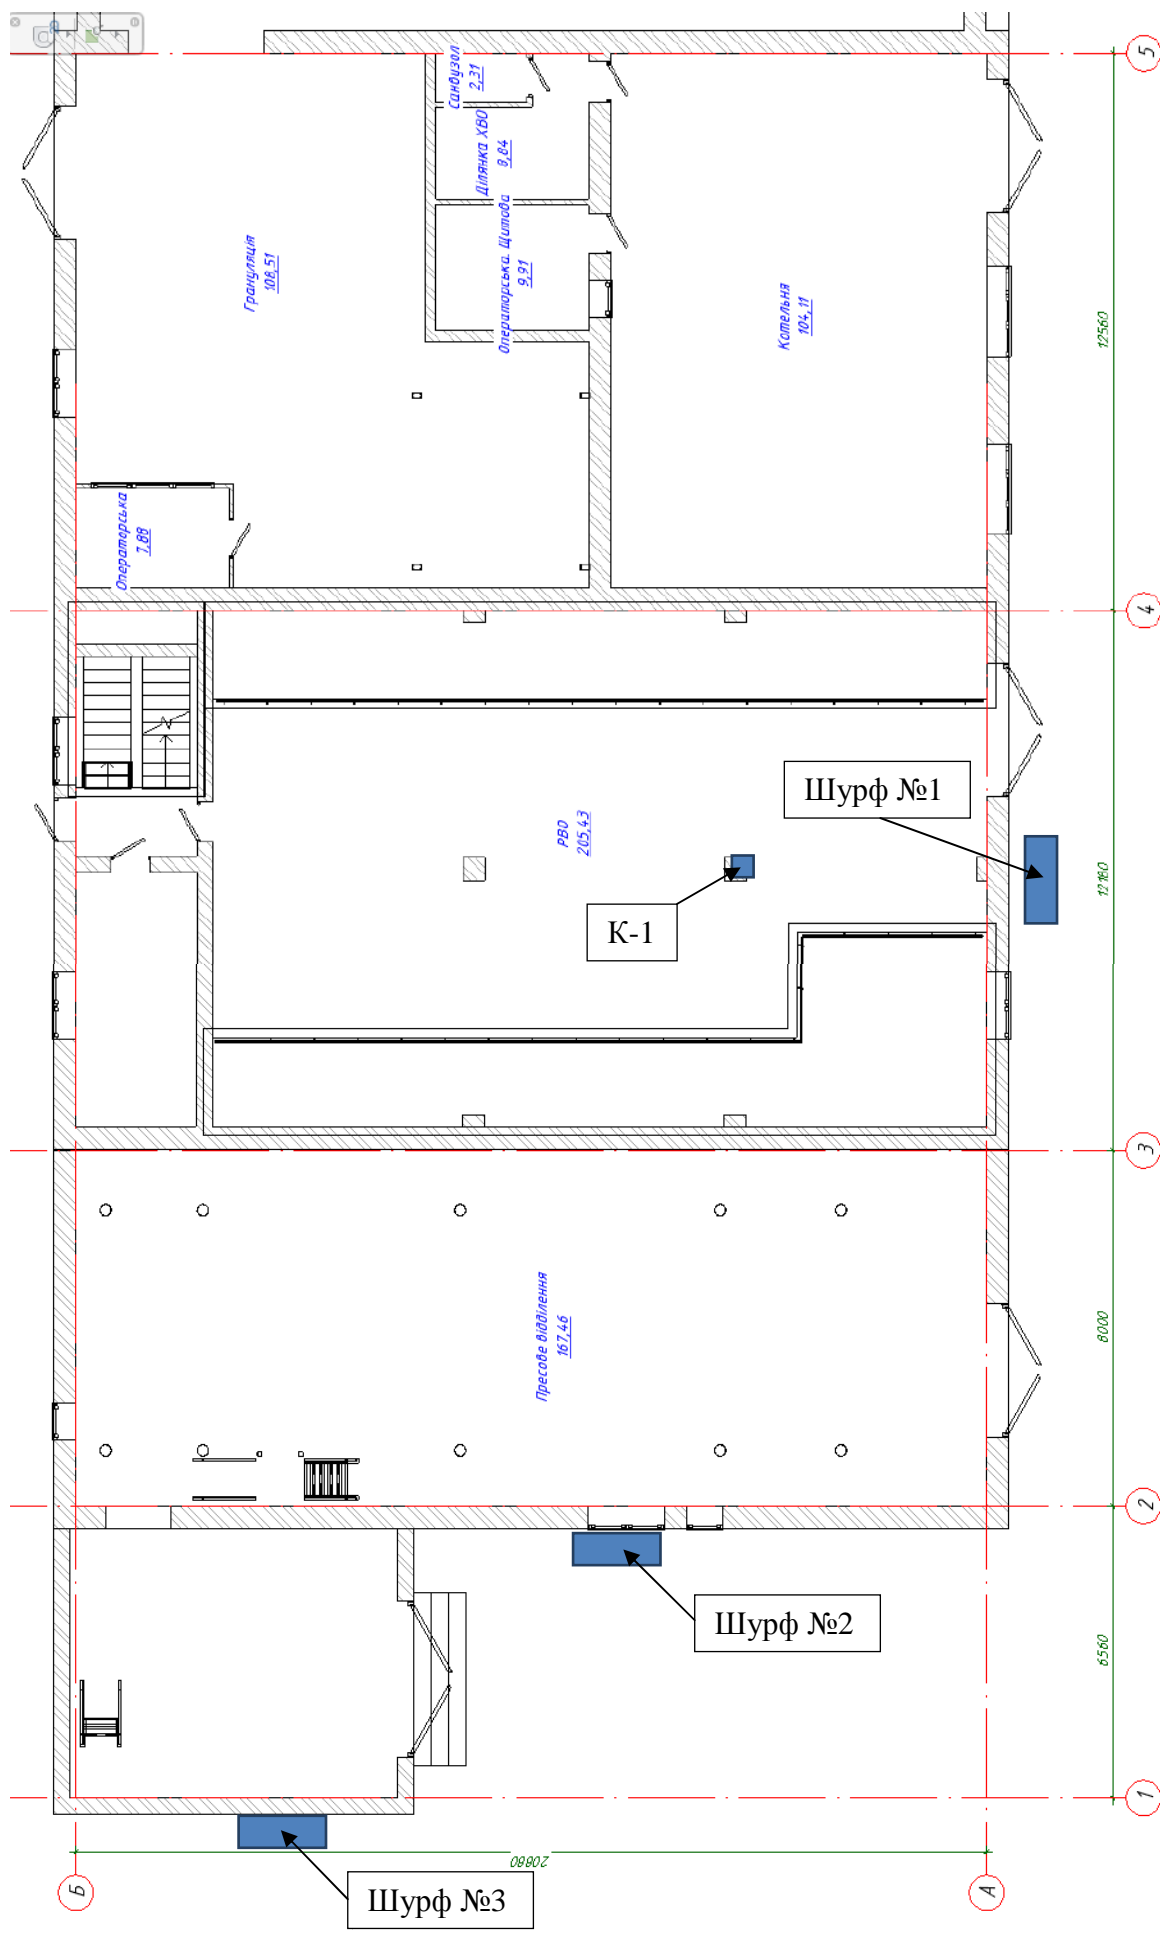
Обмірне креслення 1-го поверху Цеху по переробці олійних культур. Схема розташування шурфів та місць інструментальних досліджень залізобетонних конструкцій
